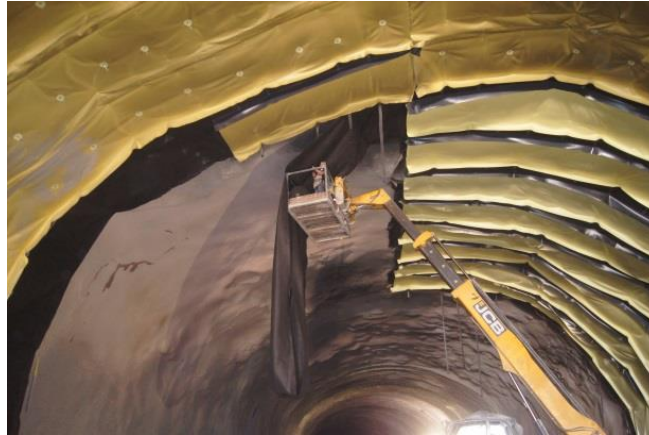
Colocación del sistema de impermeabilización, Túnel Interlomas-México 2014. (Cortesía Consultec).
